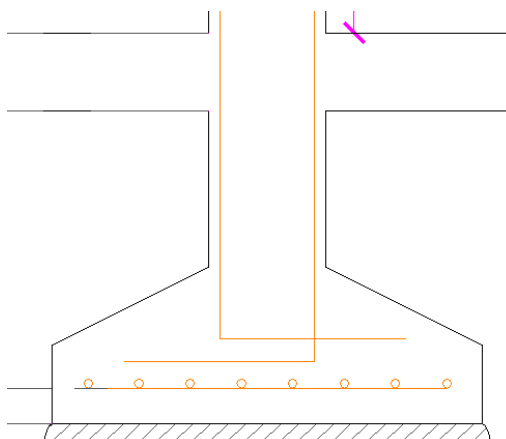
Detalle; zapata-pedestal-riosteira.
